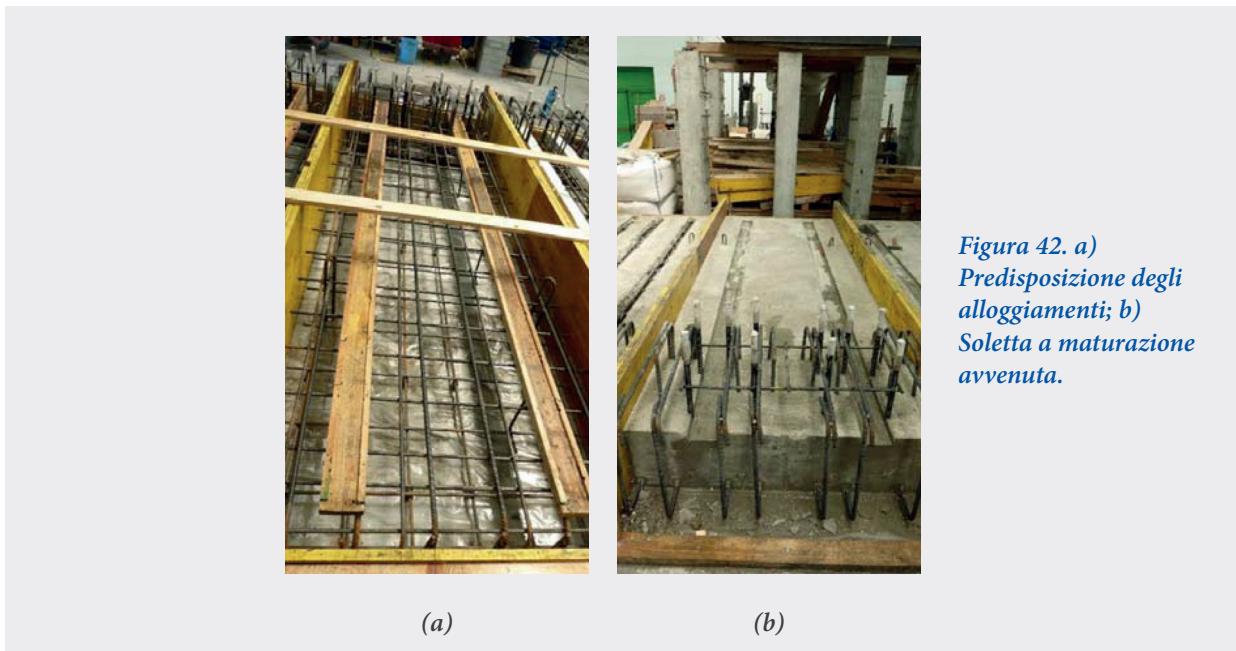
a) Predisposizione degli alloggiamenti; b) Soletta a maturazione avvenuta.
